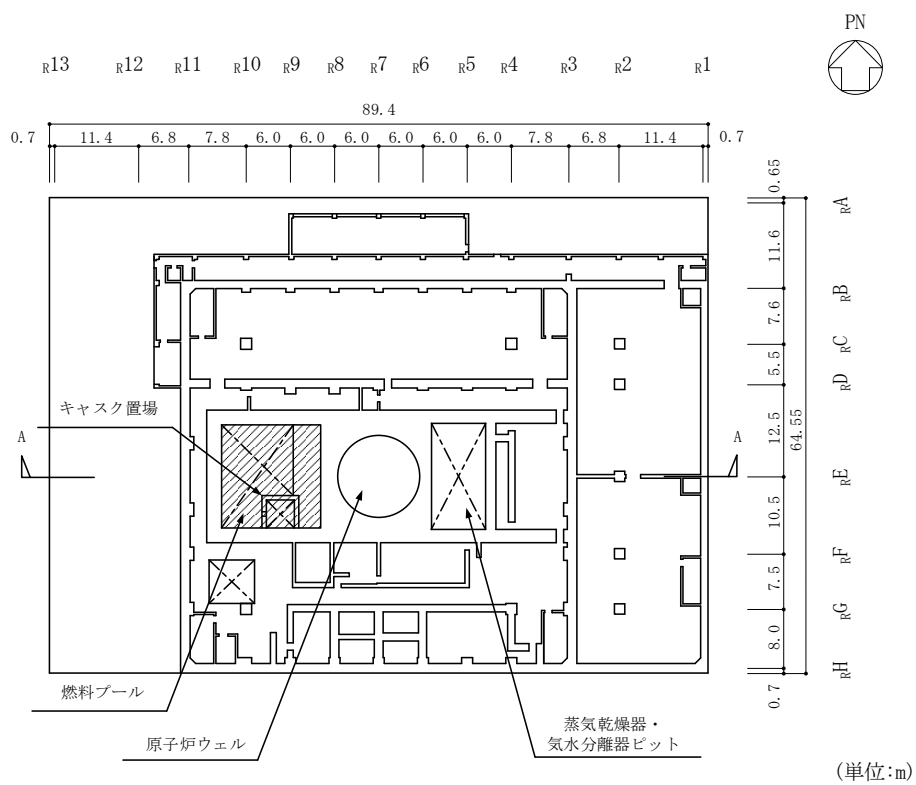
燃料プール及びキャスク置場を含む原子炉建物の概略平面図
